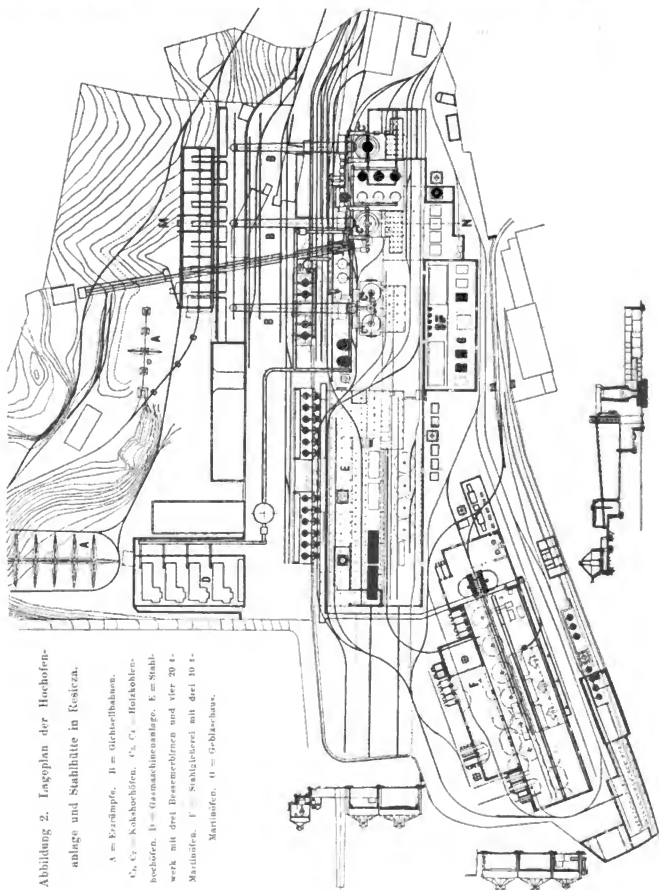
Lageplan der Hochofenanlage und Stahlhütte in Resicza.
